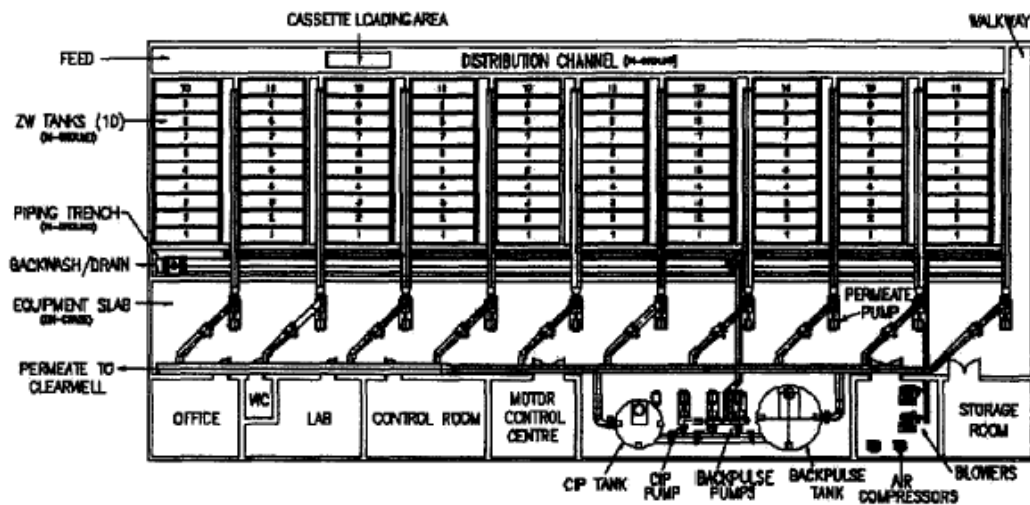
PLANTA DEL SISTEMA COMPLETO.
